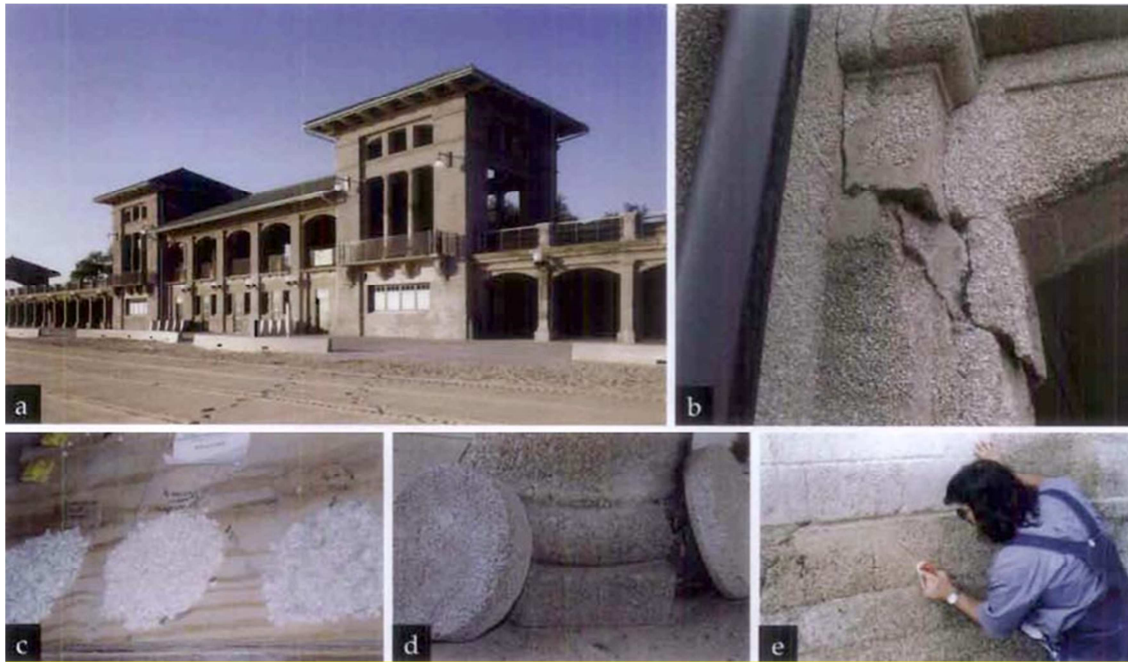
(a) La casa de la playa de la calle 63 se construyó en la costa de Chicago en 1919. El hormigón visto de las paredes exteriores de la casa se usó para muchos edificios en los parques de Chicago como una alternativa a la construcción en piedra, mucho más cara. Fotografía: Leslie Schwartz Photography. (b) El deterioro del hormigón incluyó agrietamiento, desconchado y laminación causada por la corrosión de las armaduras de acero y el daño del hormigón debido a la congelación y descongelación cíclica. (c) Se revisaron varios tamaños y tipos de áridos para que coincidieran con los materiales de hormigón original. (d) Se prepararon maquetas de la mezcla de reparación de hormigón para compararlas con el original. Se tuvo en cuenta el tipo y tamaño del árido, el color del cemento, las proporciones, la exposición del árido y el acabado de la superficie. (e) El artesano terminó la superficie para imitar la apariencia original en una maqueta en la estructura. Aquí, usó un cepillo de cerdas de nylon para quitar la pasta suelta y exponer el árido, creando una superficie variable para que coincidiera con el hormigón original.
